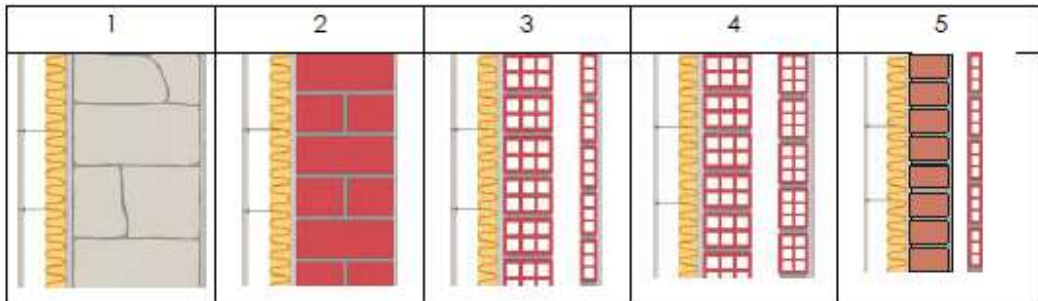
Detalle fachada ventilada con varios tipos de soporte. Fuente GREEV
